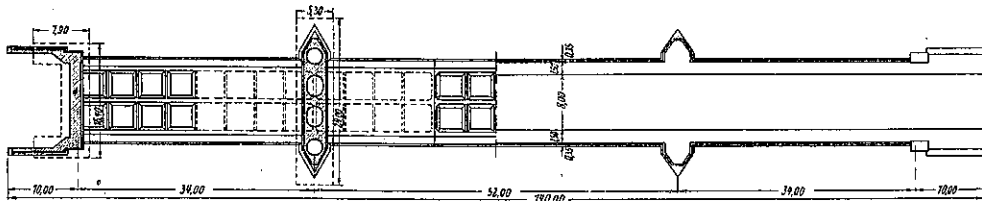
Pisa 近郊 Arno 河橋 (側面及足場図)
